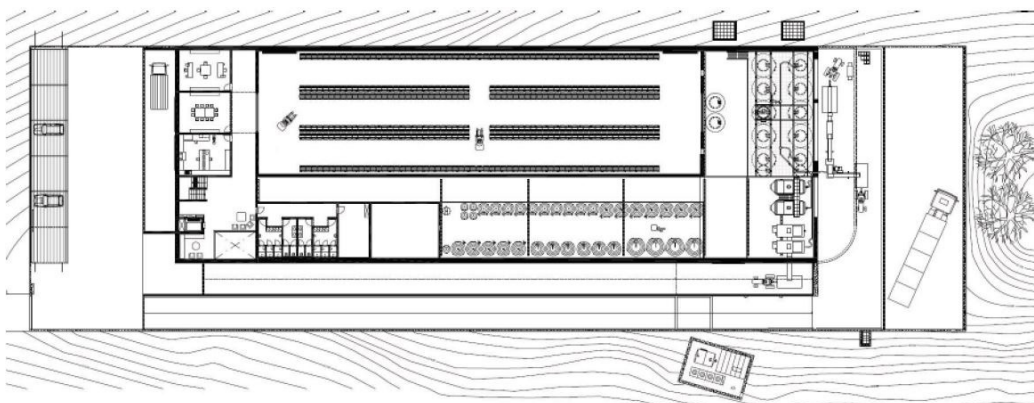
Adega Mayor - Planta do Piso 1²⁷
